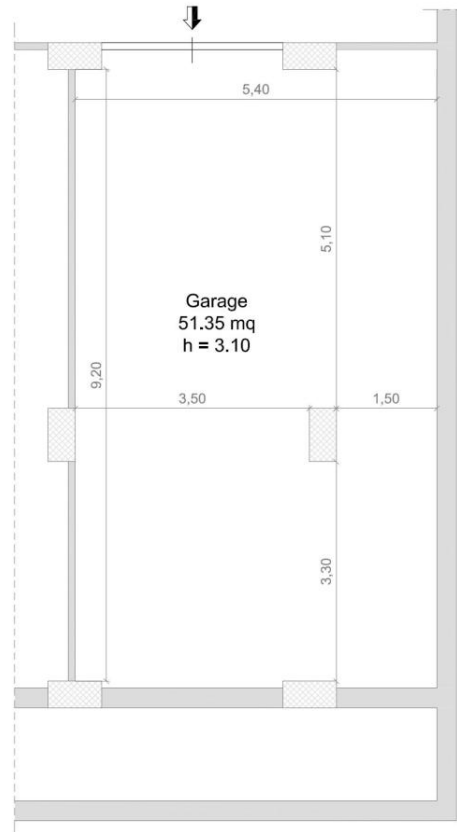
Planimetria Catastale Foglio 30, p.lla 2169, sub 27.
